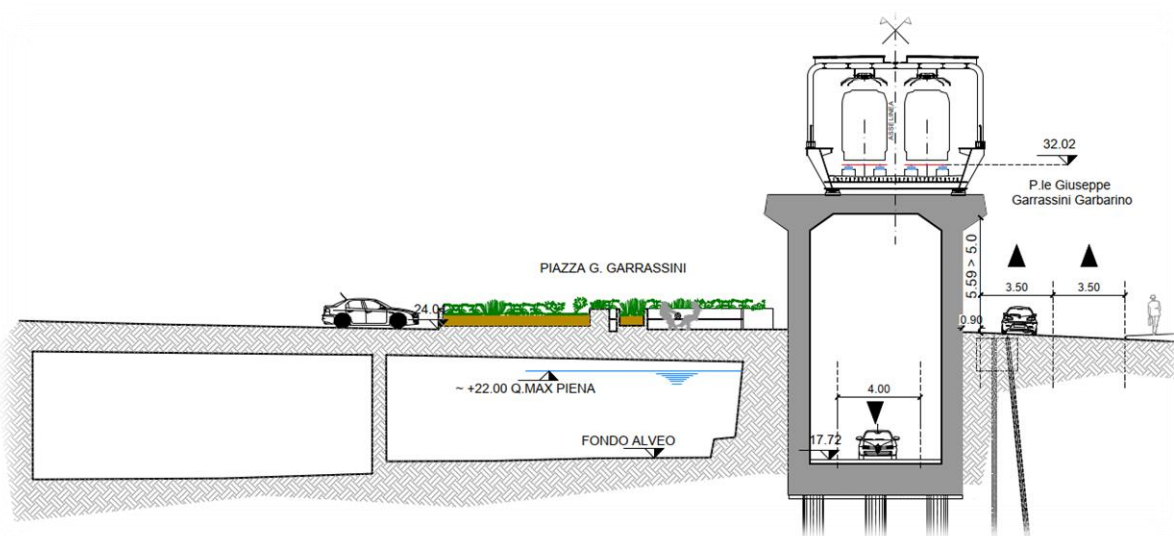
Zona Piazzale Garassini – Sezione trasversale Post Opera
